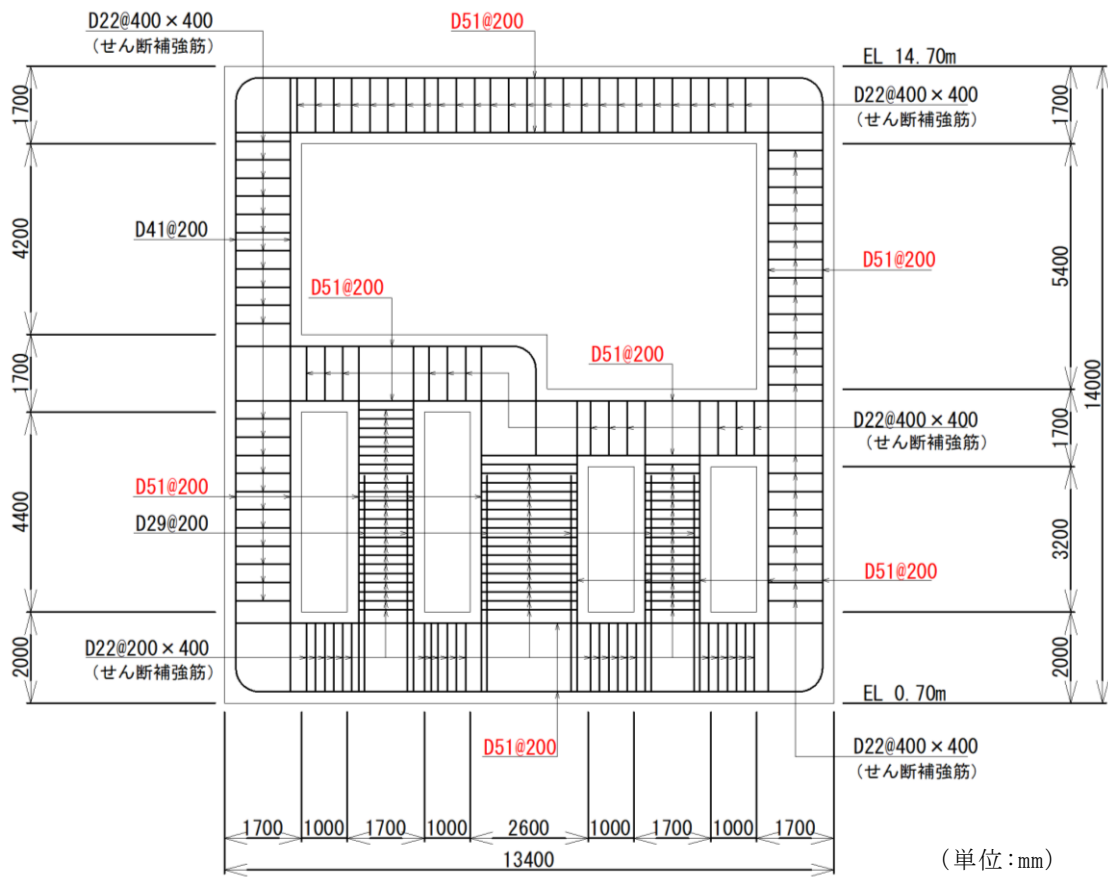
第 1 ベントフィルタ格納槽概略配筋図 (B-B 断面)
